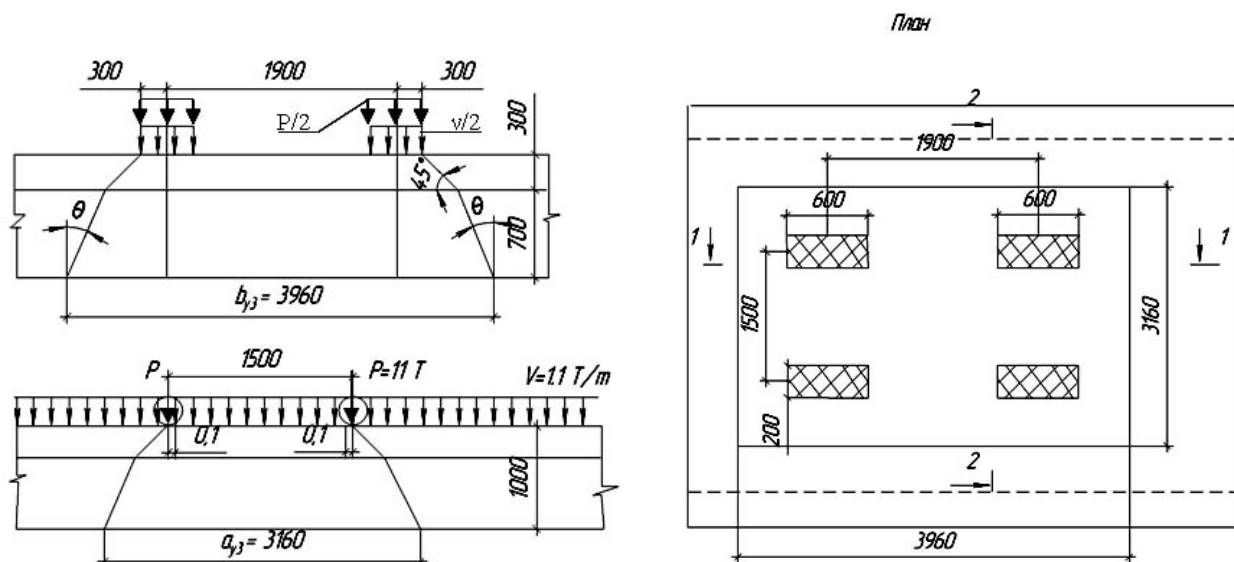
Распределение вертикальной временной нагрузки на плиты перекрытия
